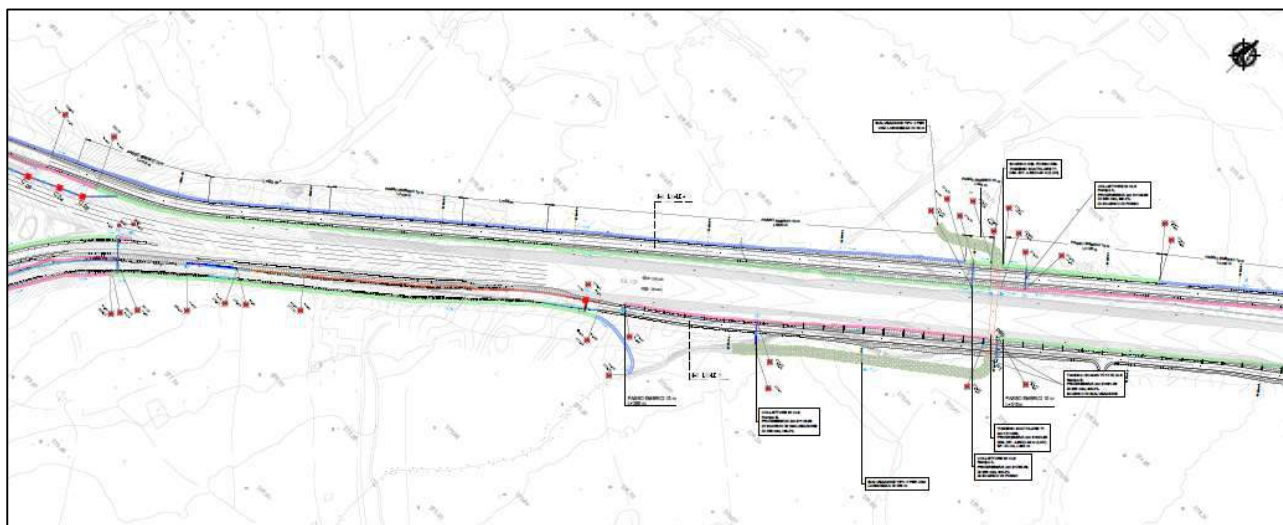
Stralcio planimetrico intervento S20-Risoluzione accessi al km 122+000, inquadramento 1/3
